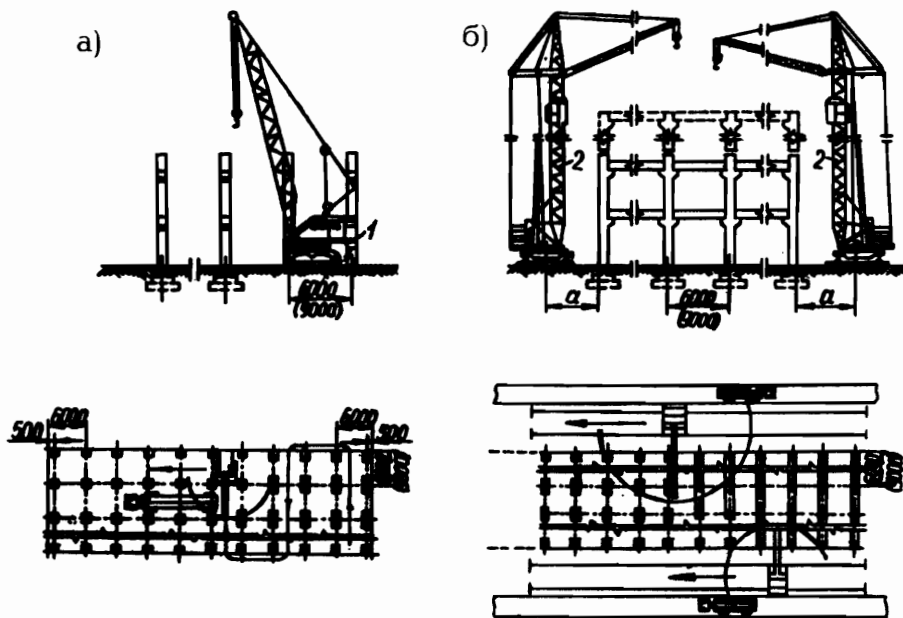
Схемы производства монтажных работ с использованием: а - стрелового крана; б - двух башенных кранов
